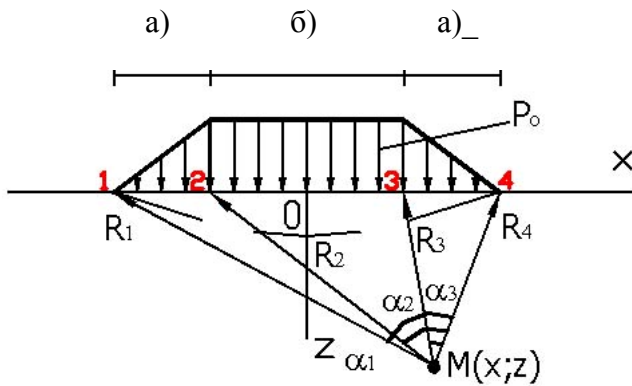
Схема к определению перемещения подошвы грунтовой насыпи
